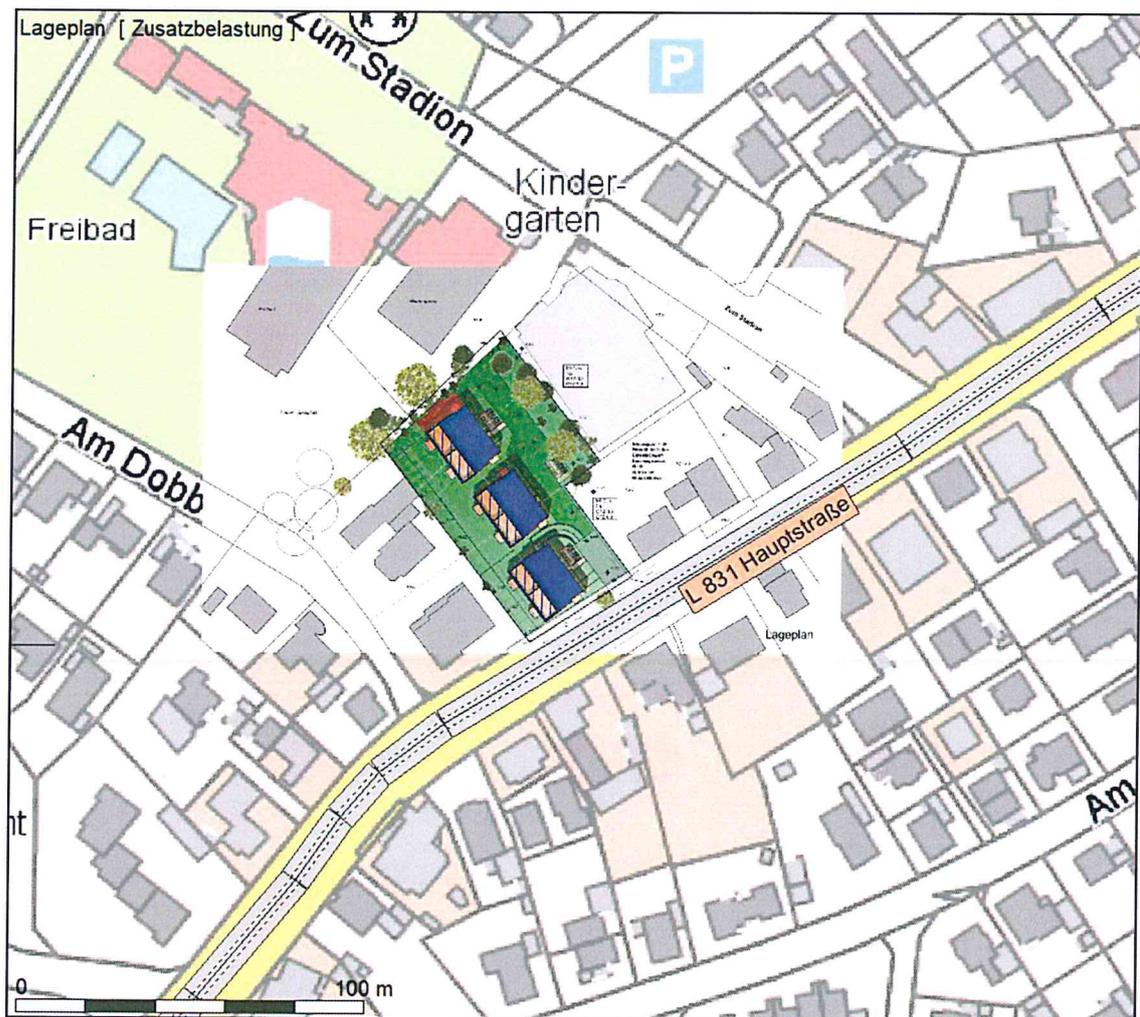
Lageplan mit dem beurteilungsrelevanten Verkehrsweg.
